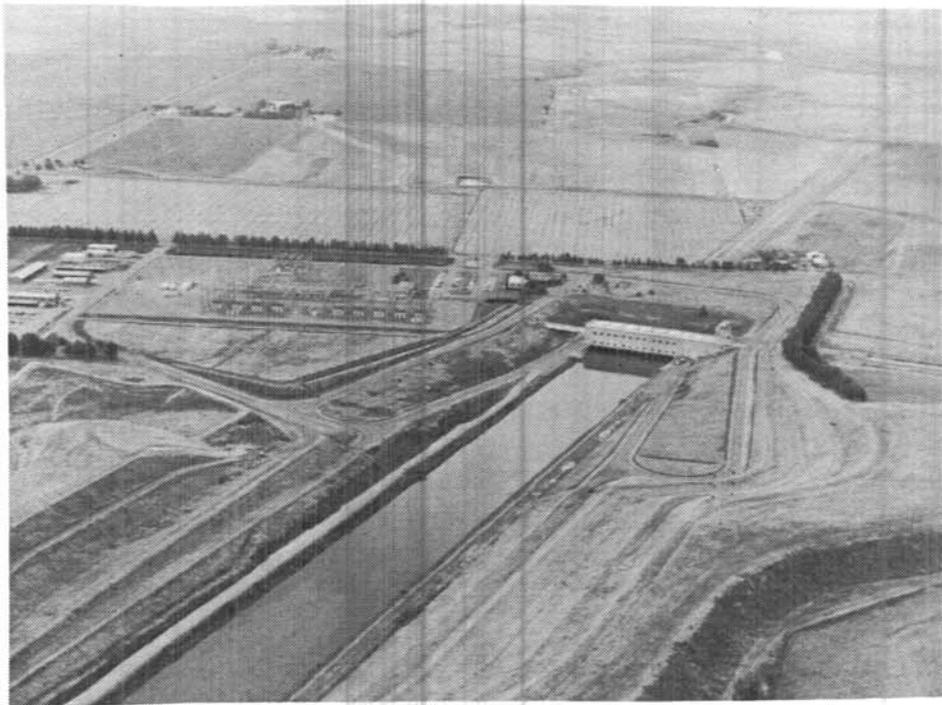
Vista aérea hacia aguas arriba del Complejo de la Planta de Bombeo Tracy, en que se ven las oficinas, la playa de distribución y la planta de bombeo, la cual eleva el agua en 60 m hasta el canal Delta-Mendoza. La planta cuenta con seis bombas, cada una propulsada por motores eléctricos de 22.500 cf y capaces de bombear a razón de 21,7 m³/seg. La energía para la planta proviene de las centrales del proyecto Central Valley. 12/4/89
